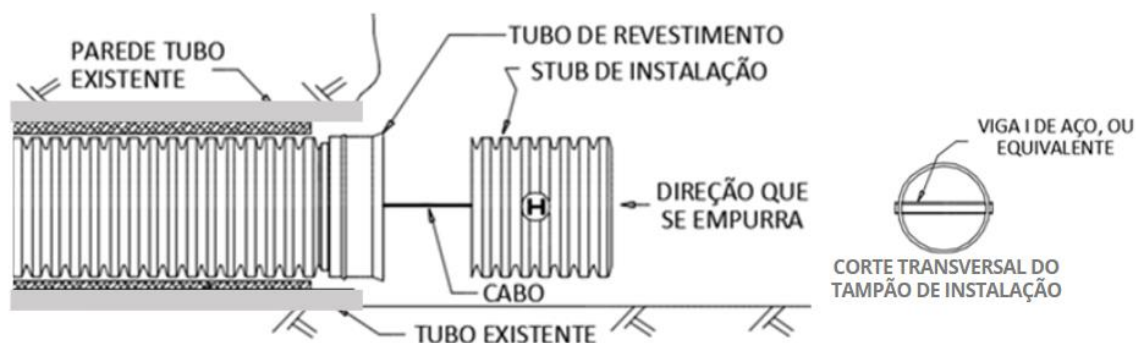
Instalação do Tubo de Revestimento Utilizando Tampão de Instalação
